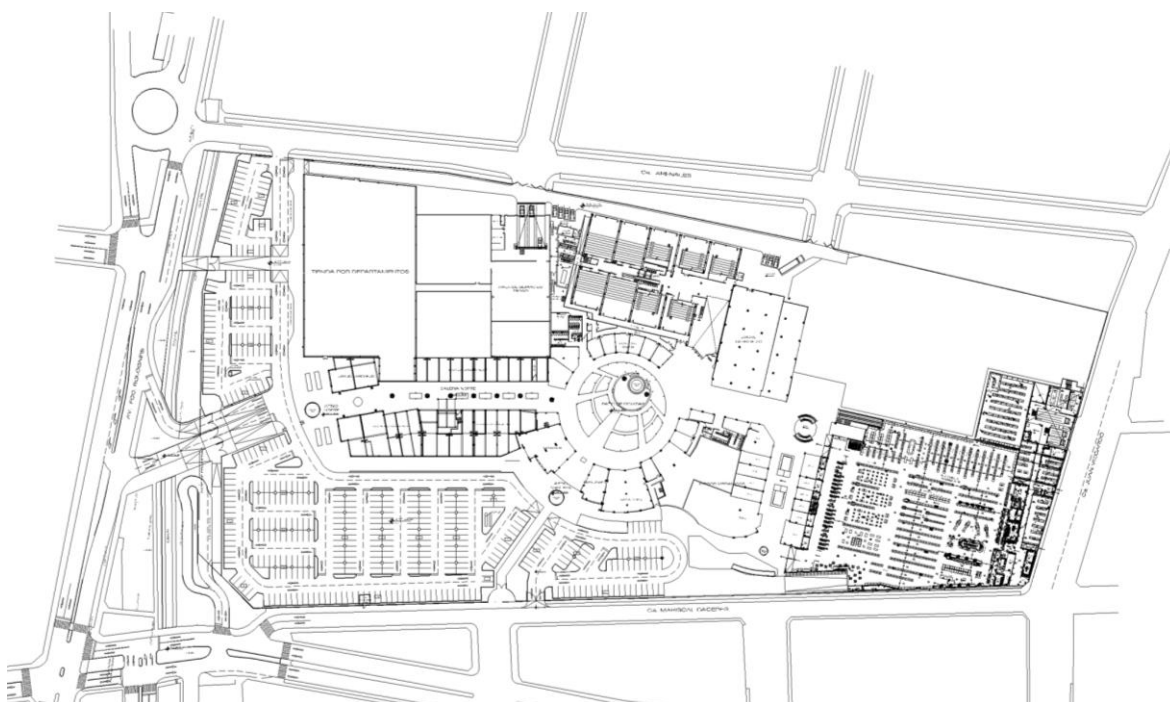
Plano de Distribución Primer Nivel del Centro Comercial Real Plaza Chiclayo
